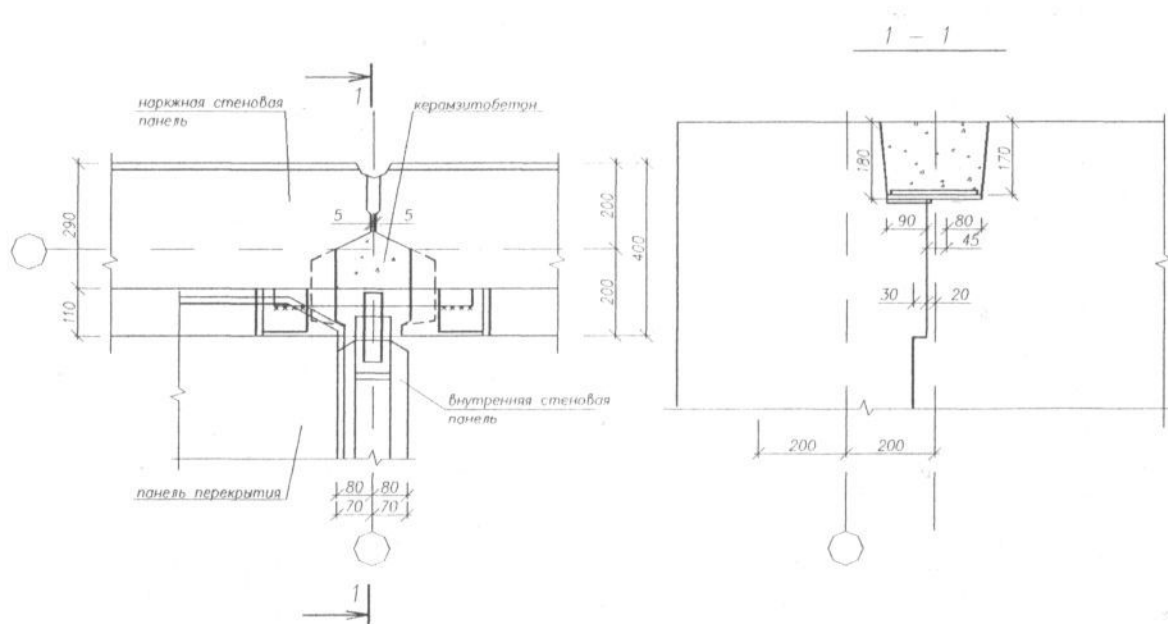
Стык наружных стеновых панелей с внутренней стеновой панелью
